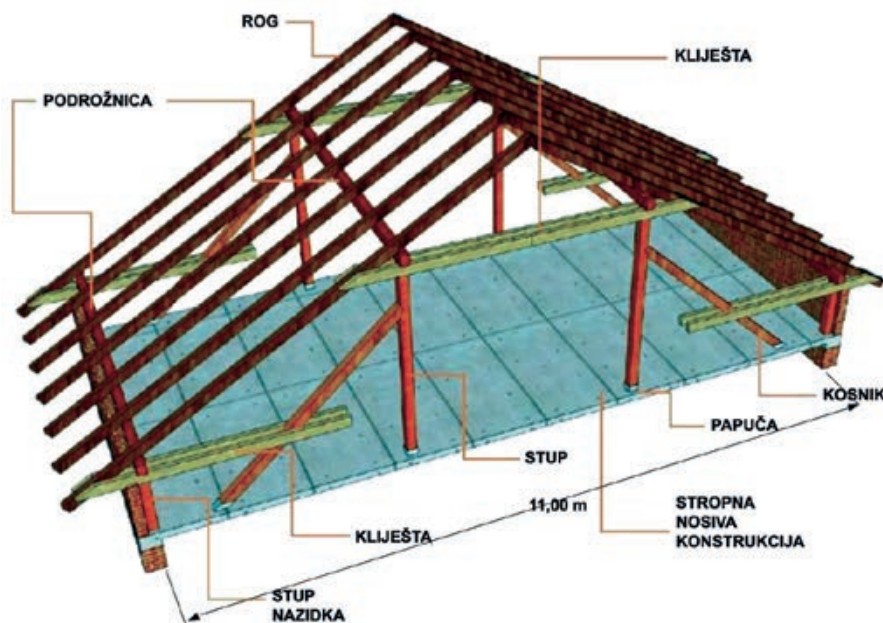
Primjeri vrsta krovnih konstrukcija [193]
